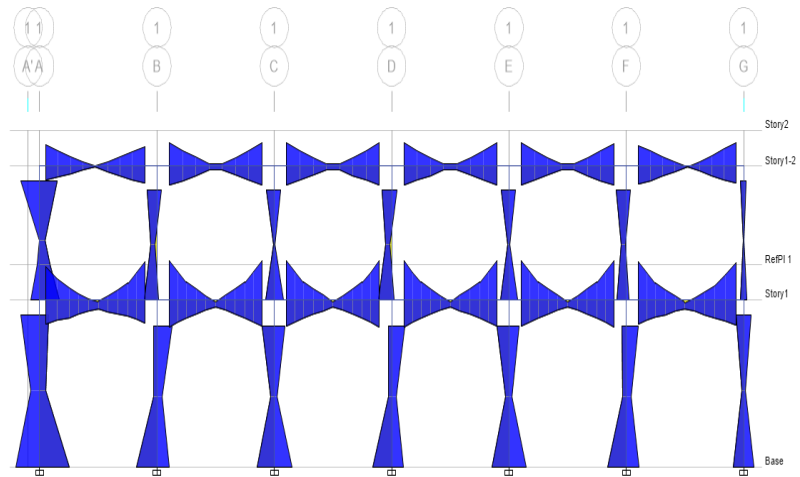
Vista longitudinal en elevación de fuerzas internas del módulo analizado.
